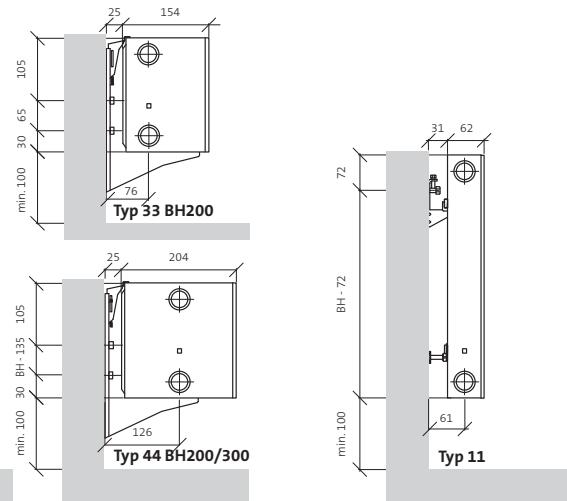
Montagemäße für Ramo Ventil Compact Typ 11
